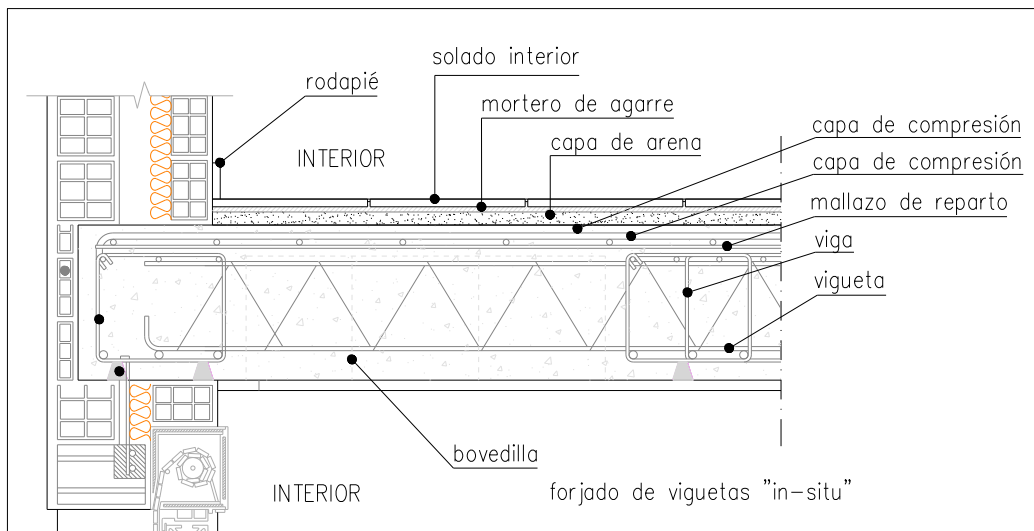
Detalle constructivo del suelo en contacto con planta semisótano
